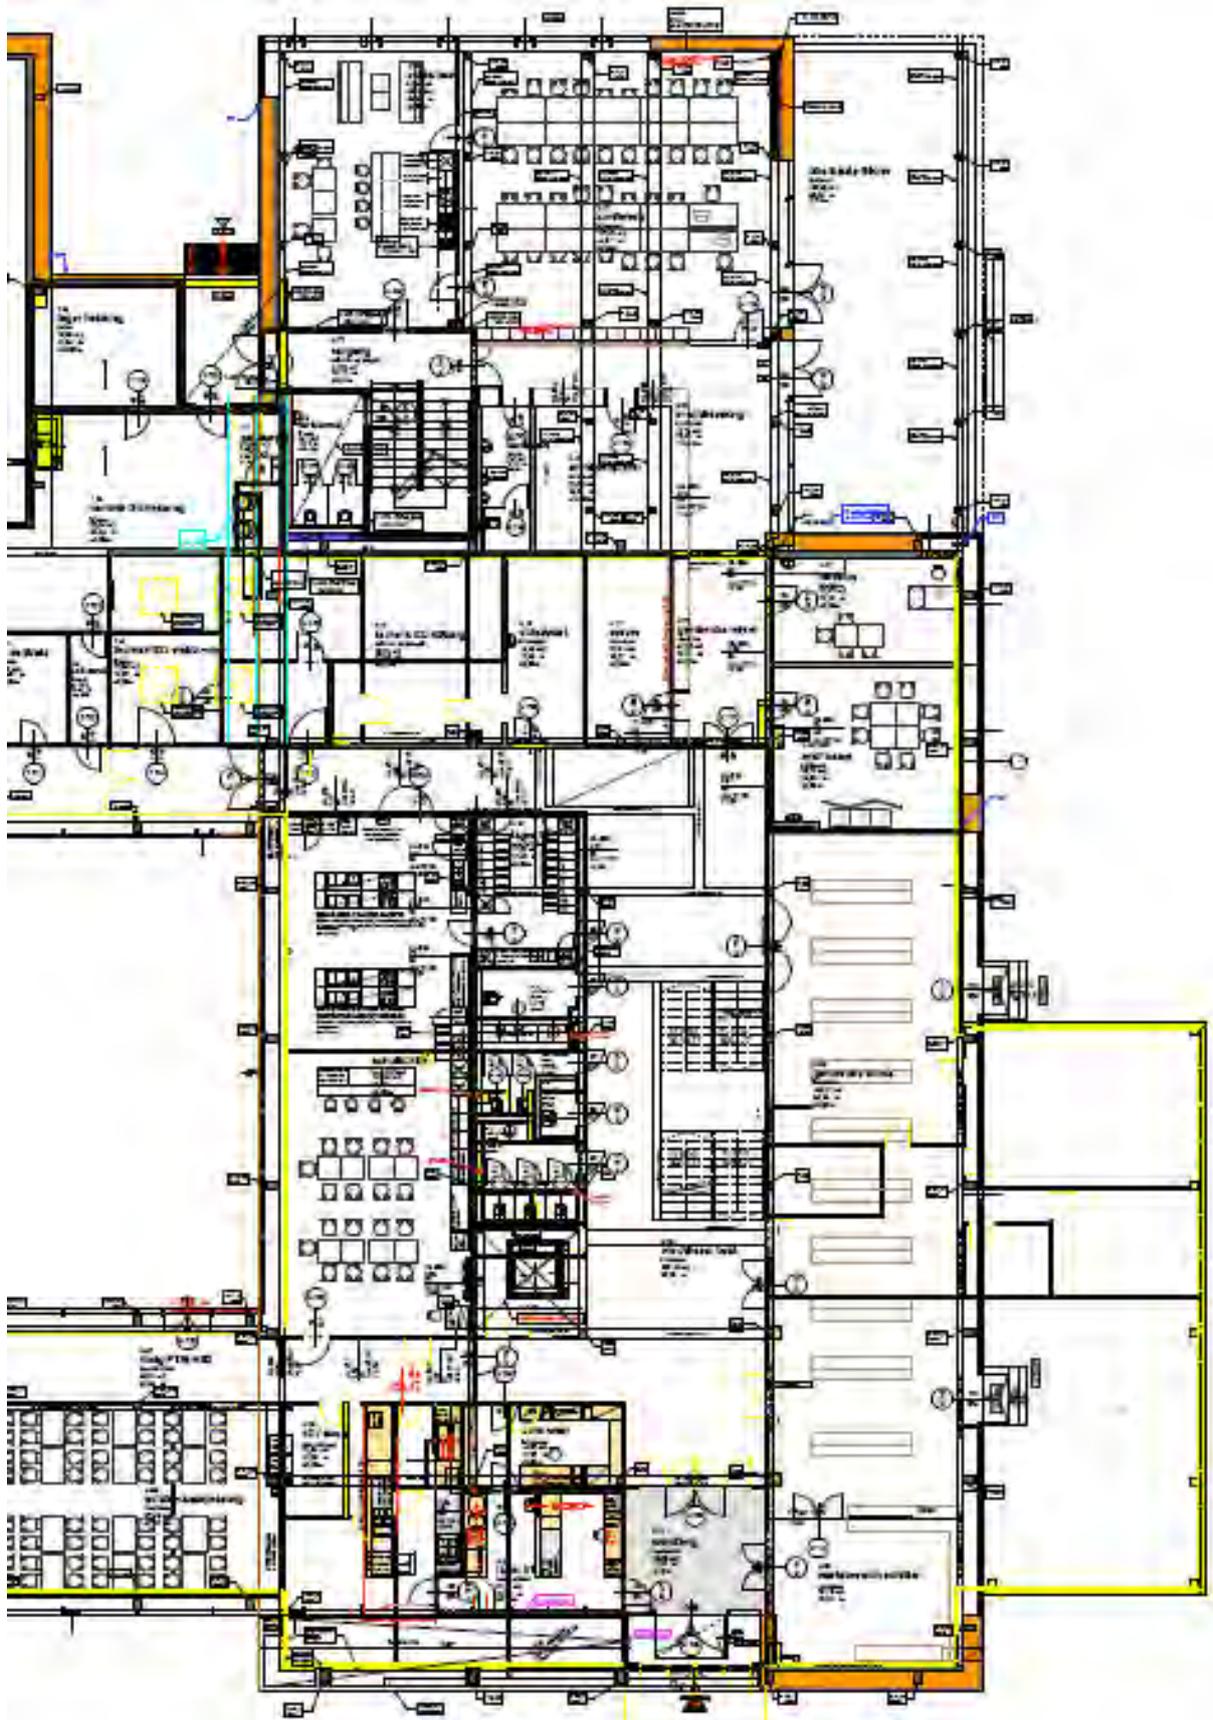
Sanierungsplan HS II, Erdgeschoss samt Einrichtung
